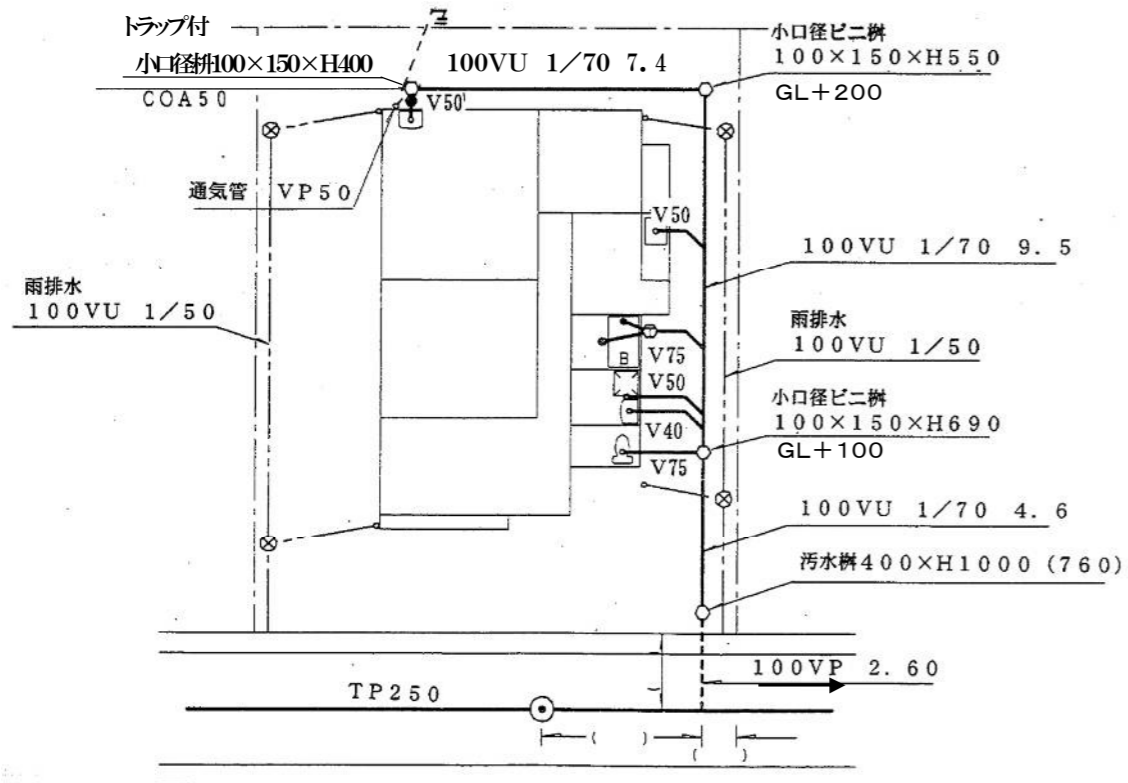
排水設備標準図 (例 2) 平面図縮尺 1/200
